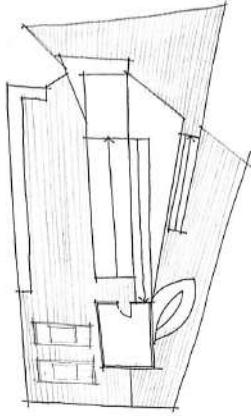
Planta baja de la casa digital\_elaboración propia
